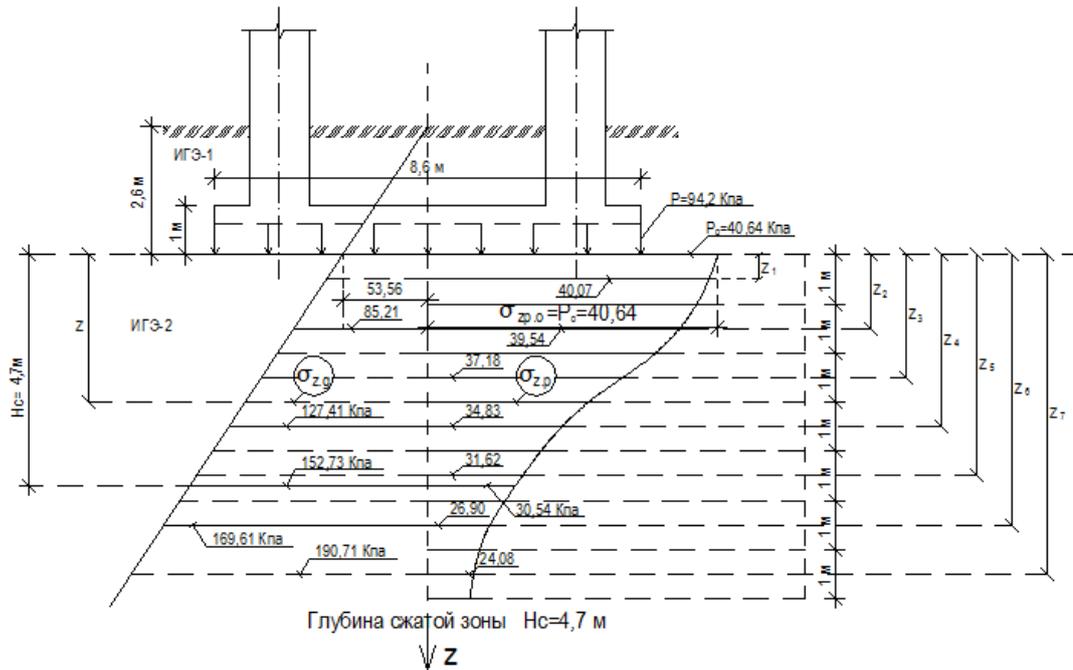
Эпюры σ_{zp} и σ_{zg} для определения осадки фундамента под точкой О (центр подошвы)
